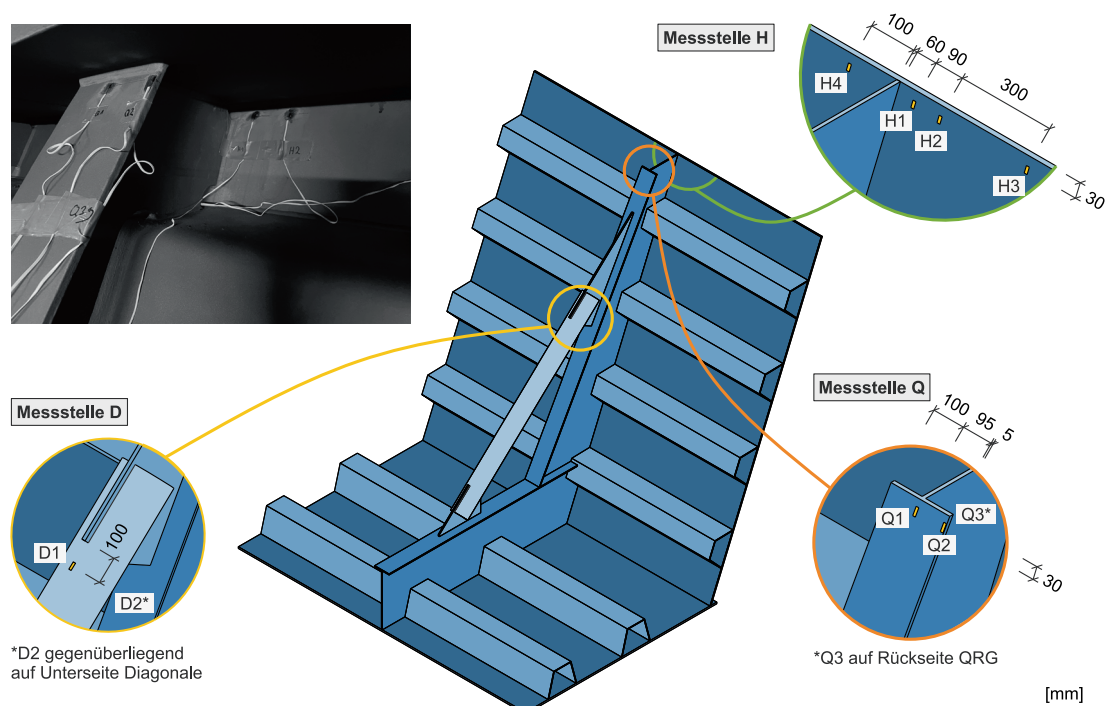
Messtechnik am untersuchten Querrahmen der Talbrücke Ganslandsiepen
